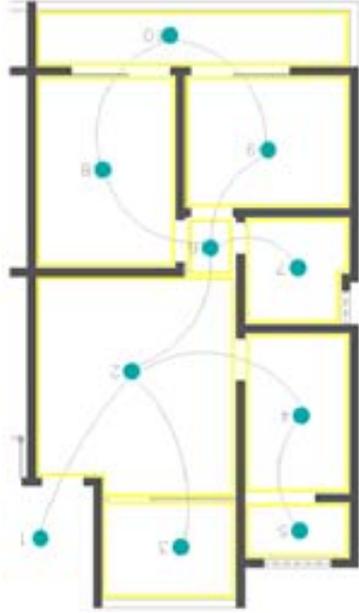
QELC 03 – Bloco A11 - Planta Original
